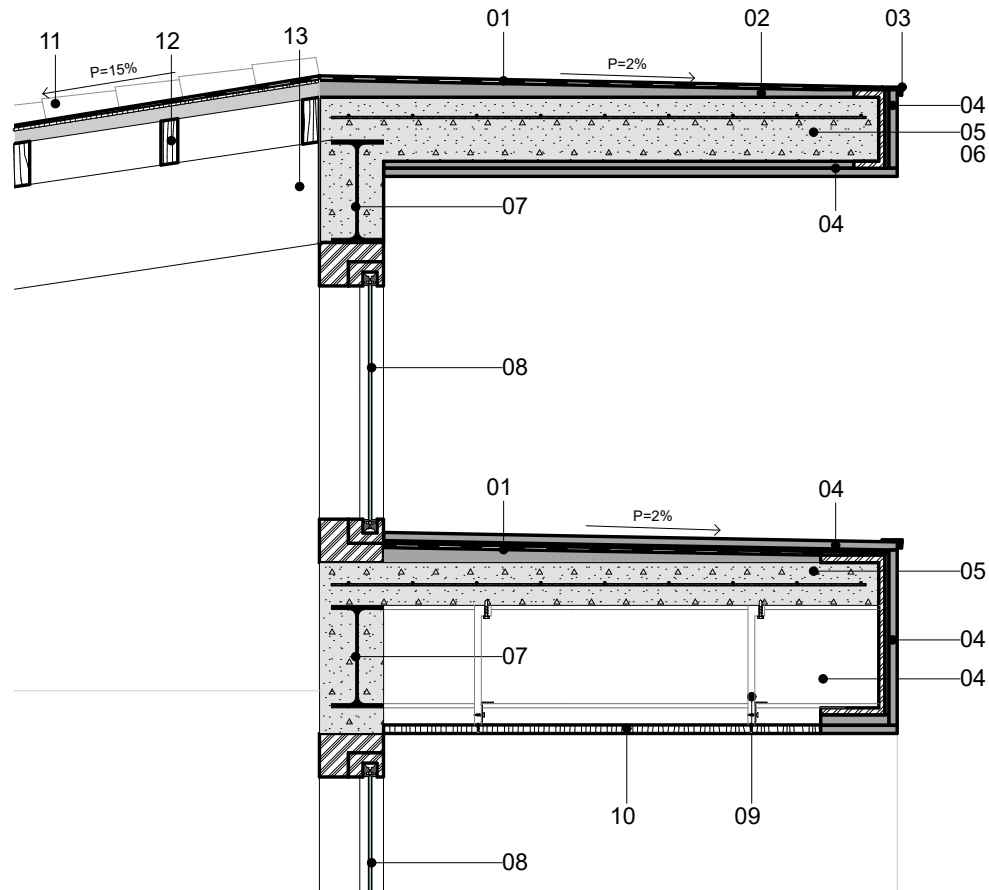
Detalle constructivo 03 Fuente: Elaboración Propia
